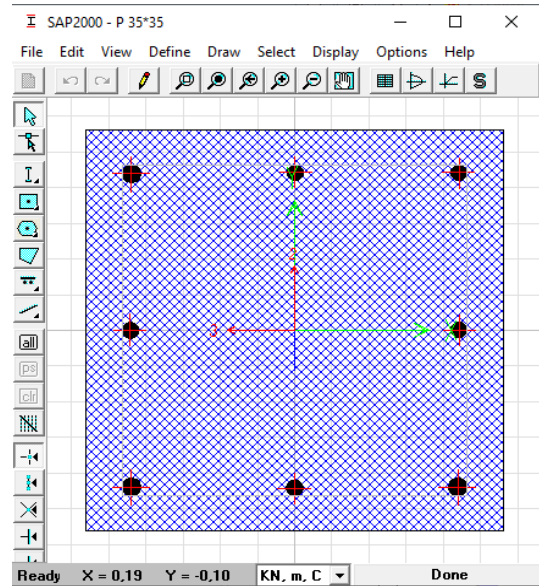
Dessin de ferrailage des poteaux (35×35)
